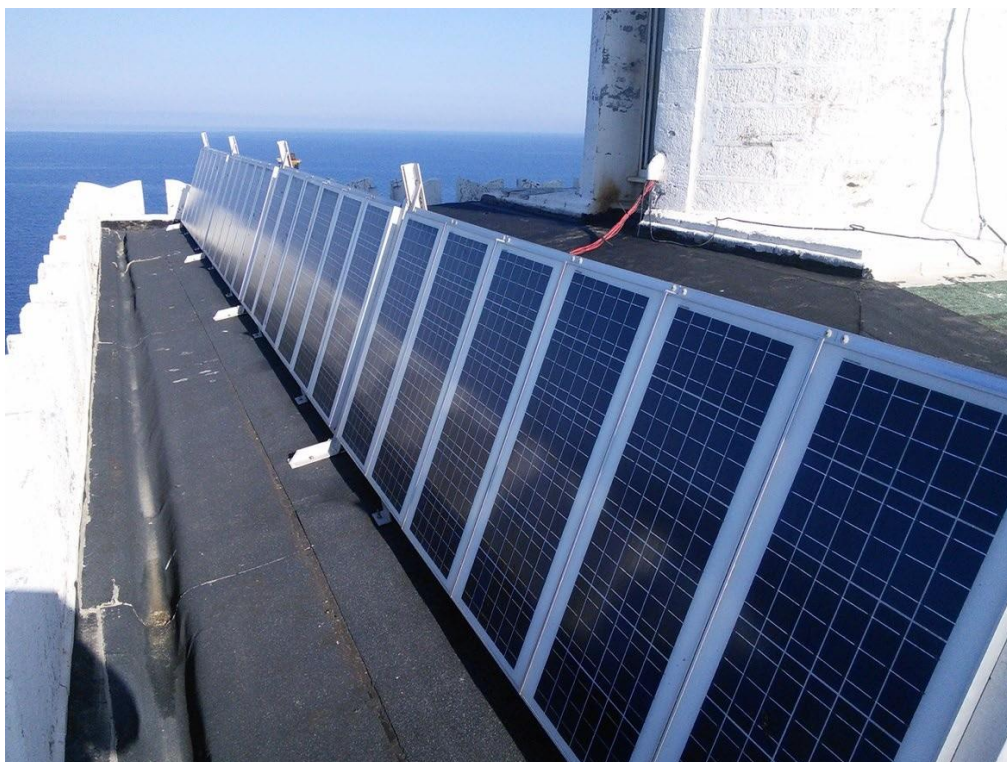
Photo d'une installation de panneaux solaires sur le phare de La Giraglia, en Corse
